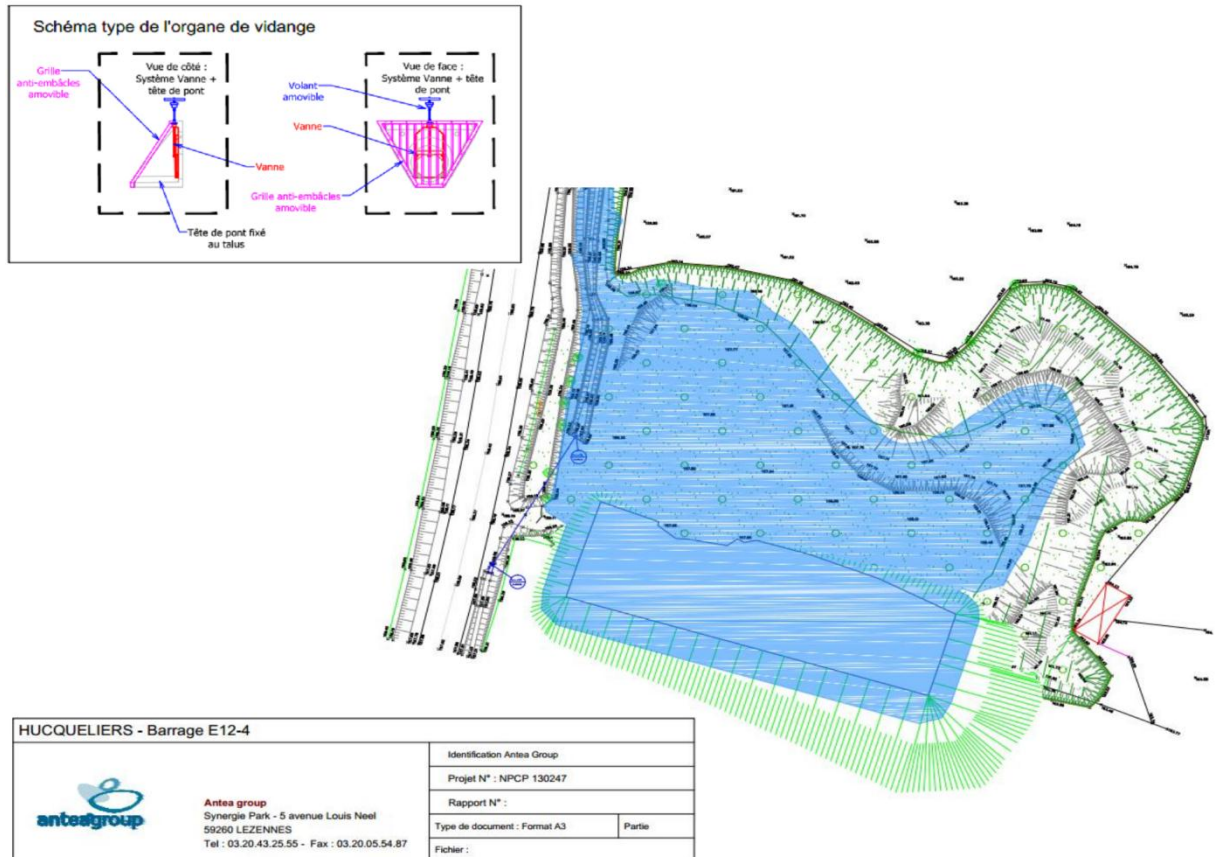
Extrait du plan de masse – Ouvrage E12-4
